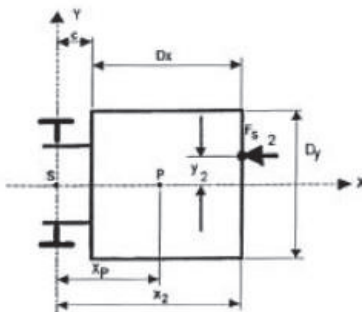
8 Vista superior del ascensor con distribución de cargas
